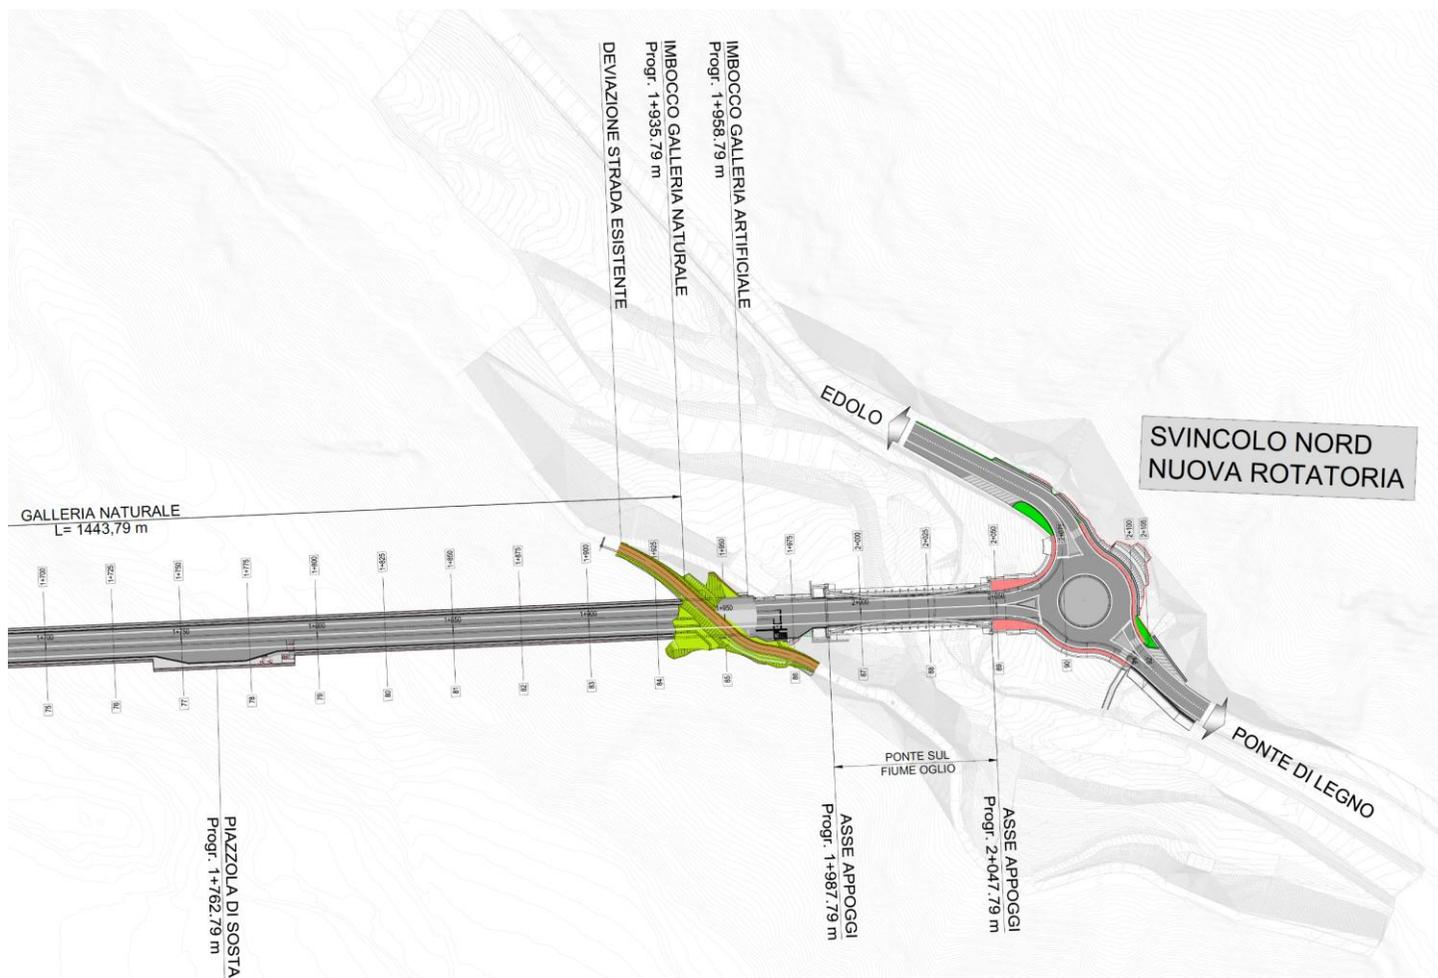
Schema planimetrico a piano strada - Tratto Nord
